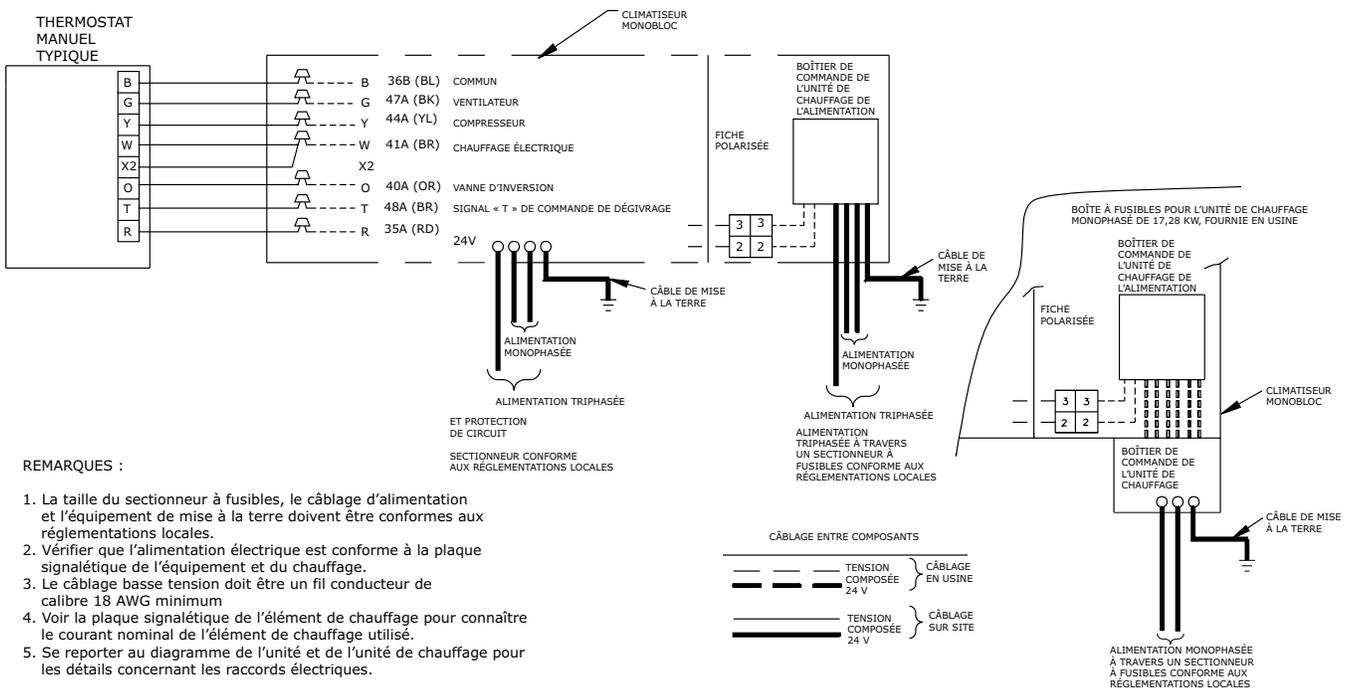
Schéma de raccordement sur site (avec chauffages supplémentaires)
